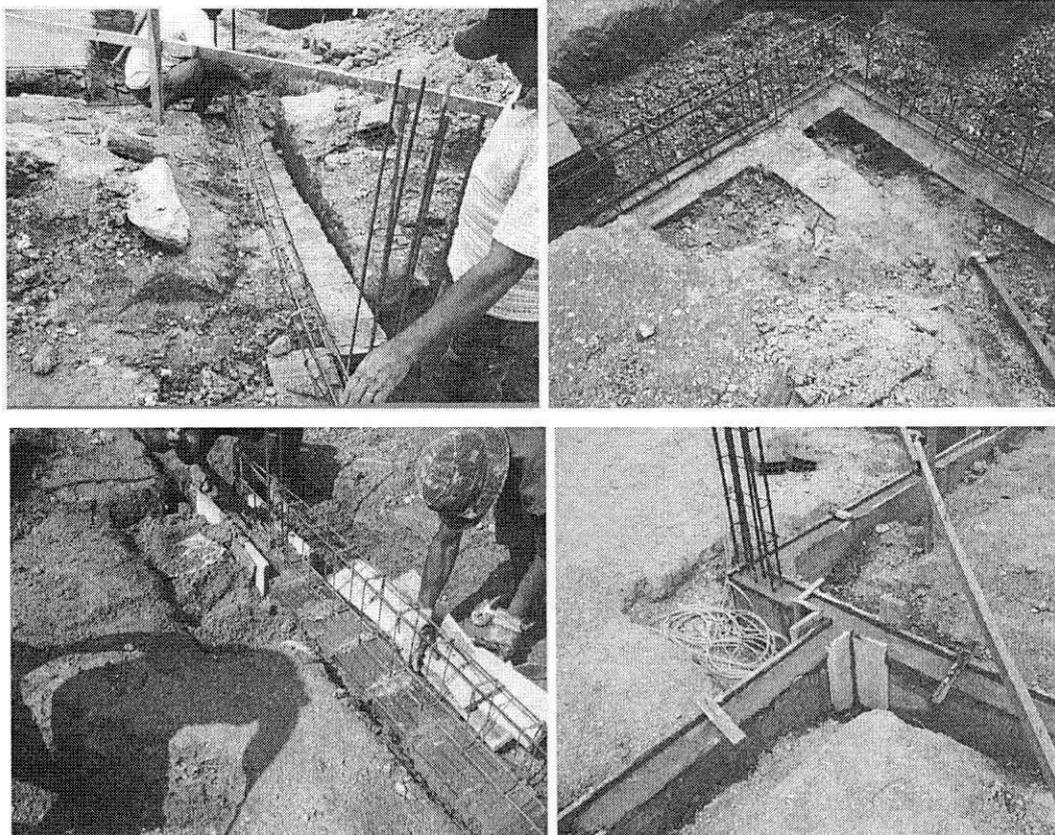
a 55 – Colocação das ferragens e concretagem das cintas
